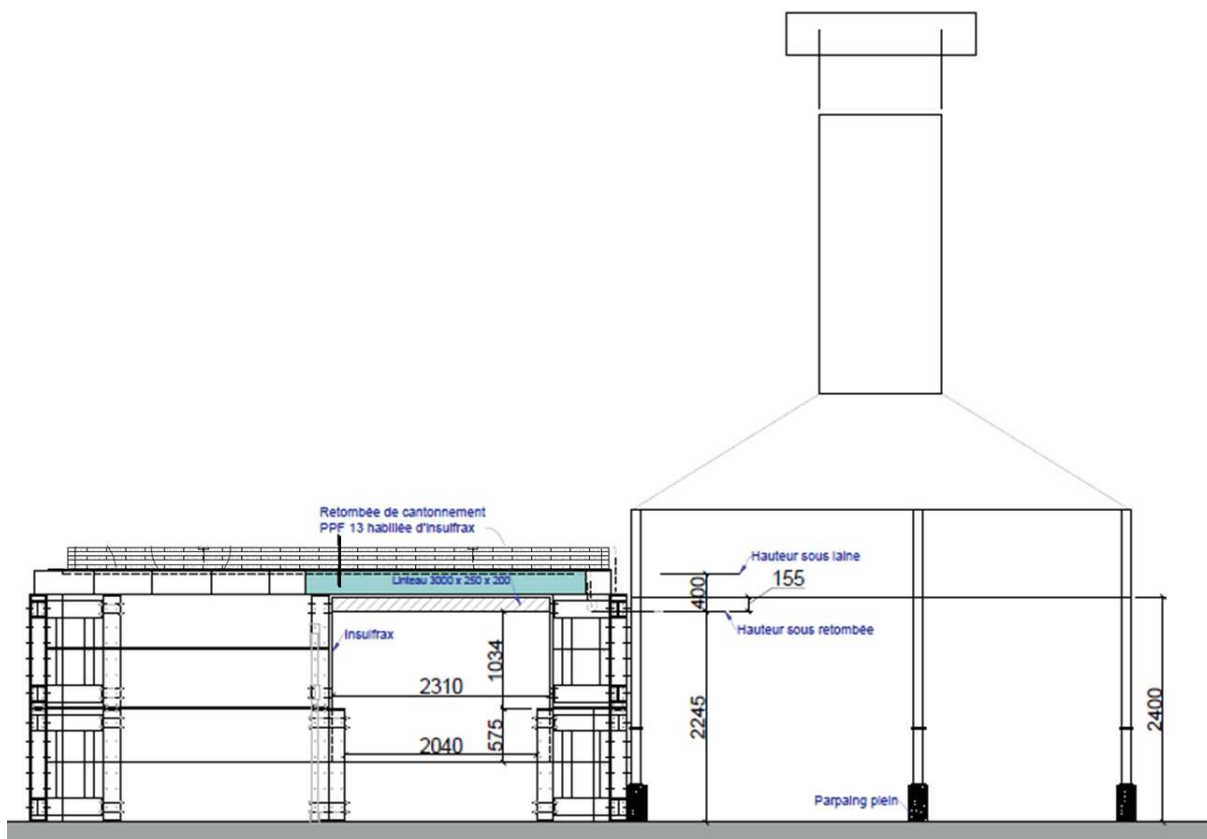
Élévation Ouest de la cellule d'essai pour les essais 2 et 4 (plafond CLT)
